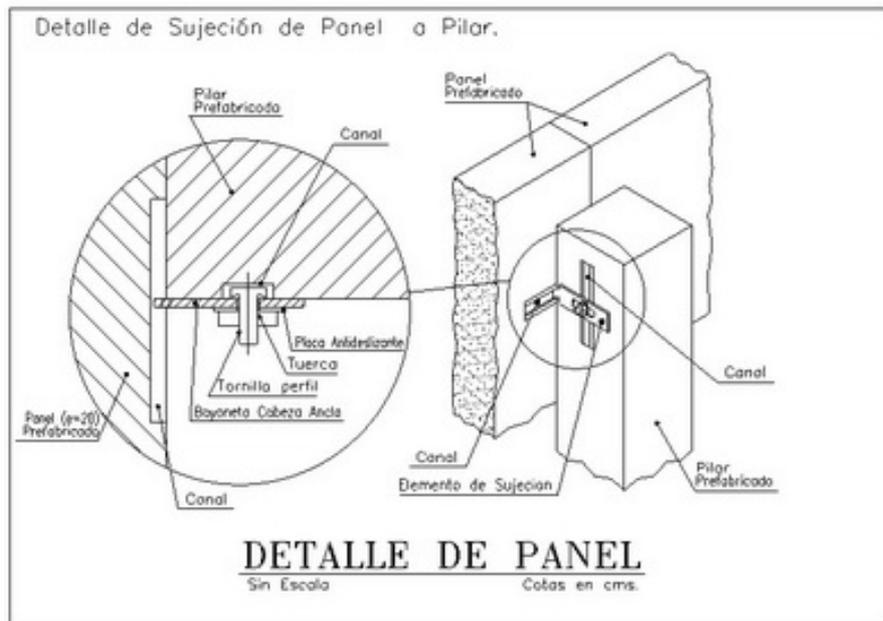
Detalles uniones de paneles de hormigón prefabricado.
